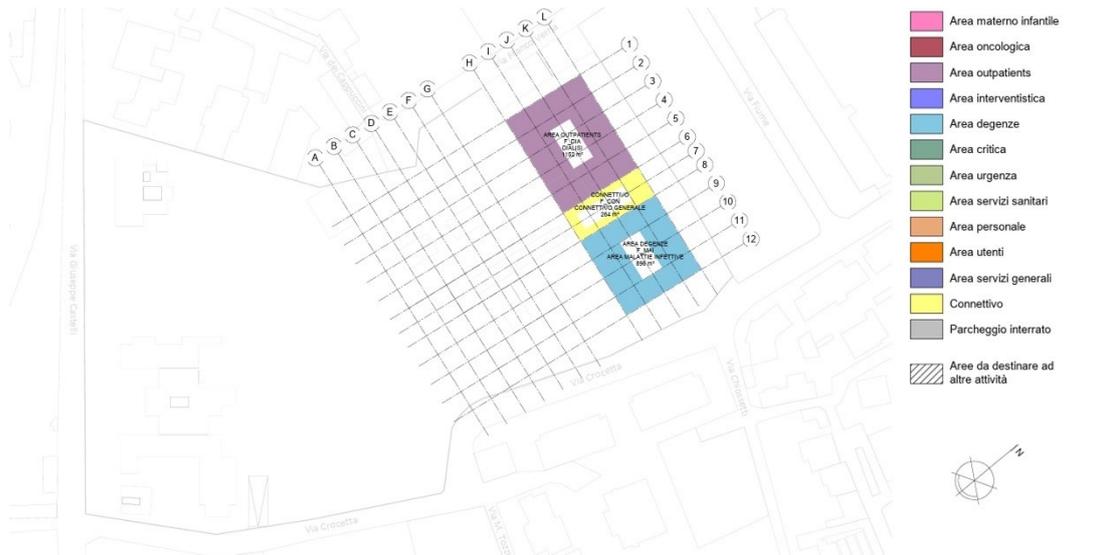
Distribuzione funzionale – Pianta piano quarto. FONTE: Elaborazione dell'autore.
